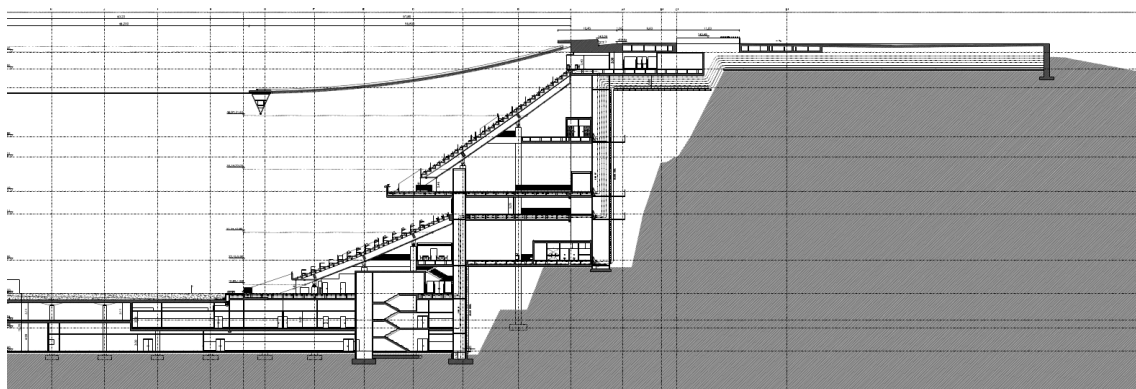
Corte Longitudinal - Bancada Poente, Eduardo Souto Moura, 2003
